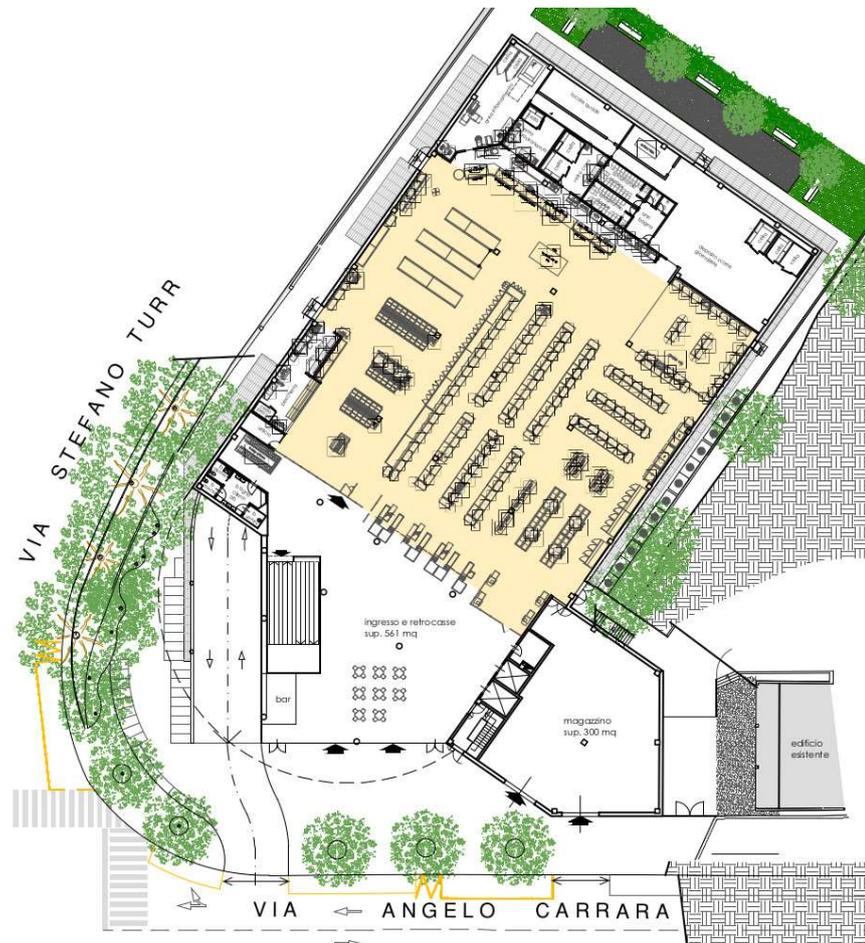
Pianta piano terra di progetto, in giallo la MSV, 1500 mq.
